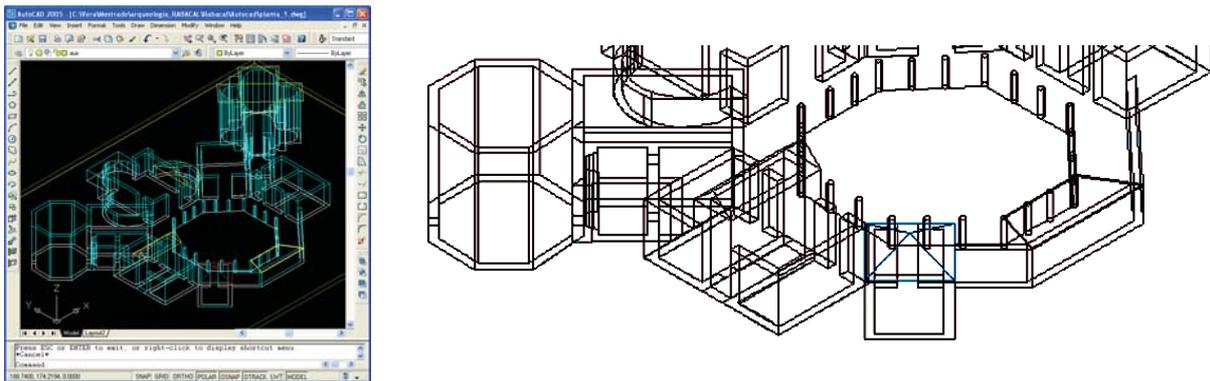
Extrusão da planta da *Villa* em AutoCad (esq.) e detalhe em negativo (drt).
